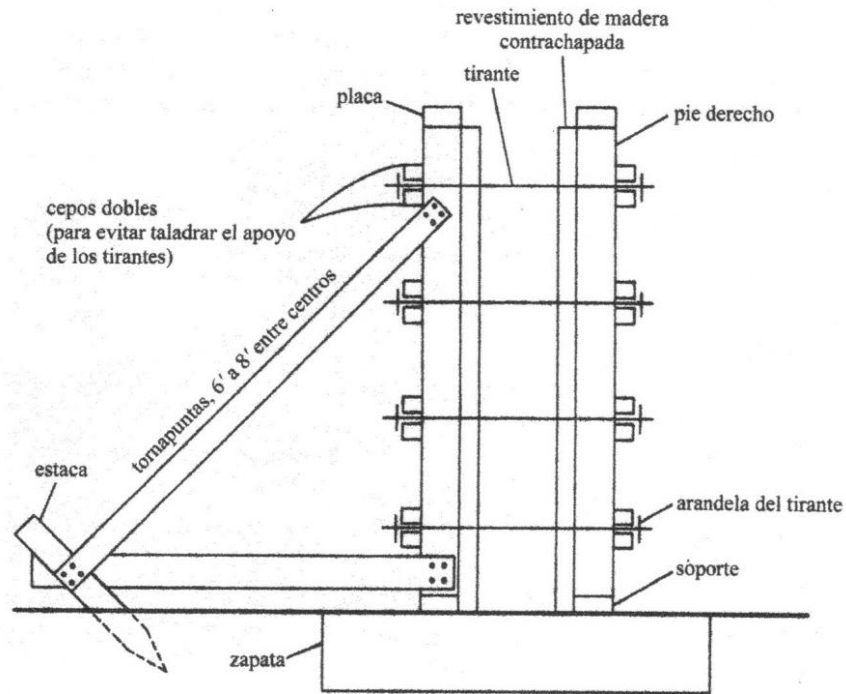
Cimbras de madera para un muro (McCormac, Brown).
